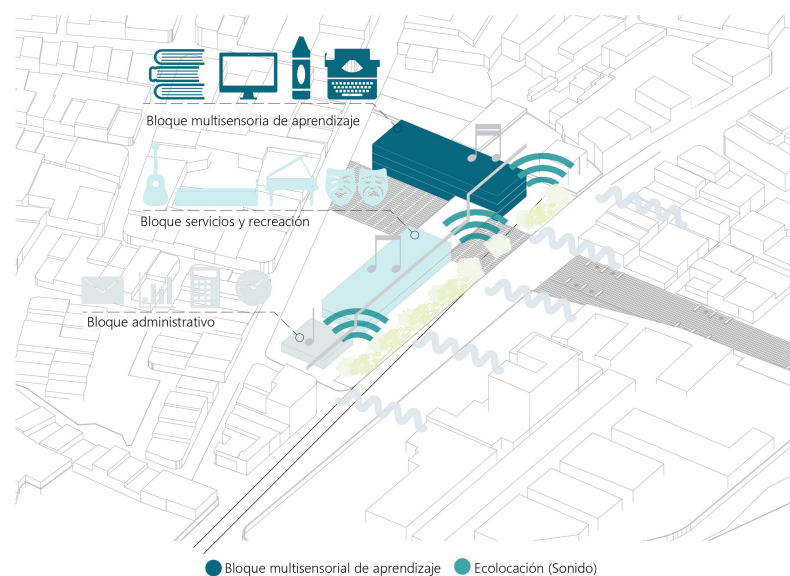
Bloque multisensorial de aprendizaje. Elaboración: Autor.
